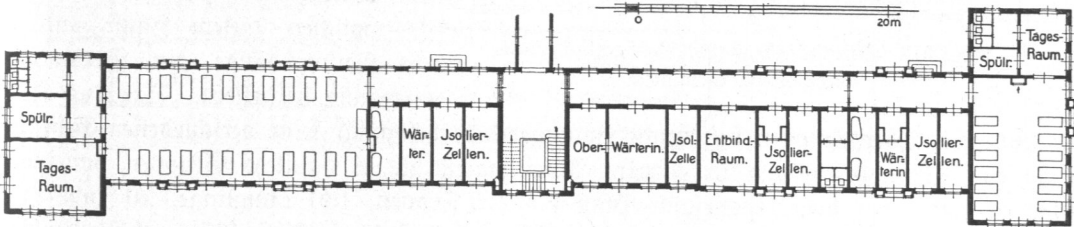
Hafenkrankenhause, Krankenpavillon, Erdgeschoß, Grundriß.
